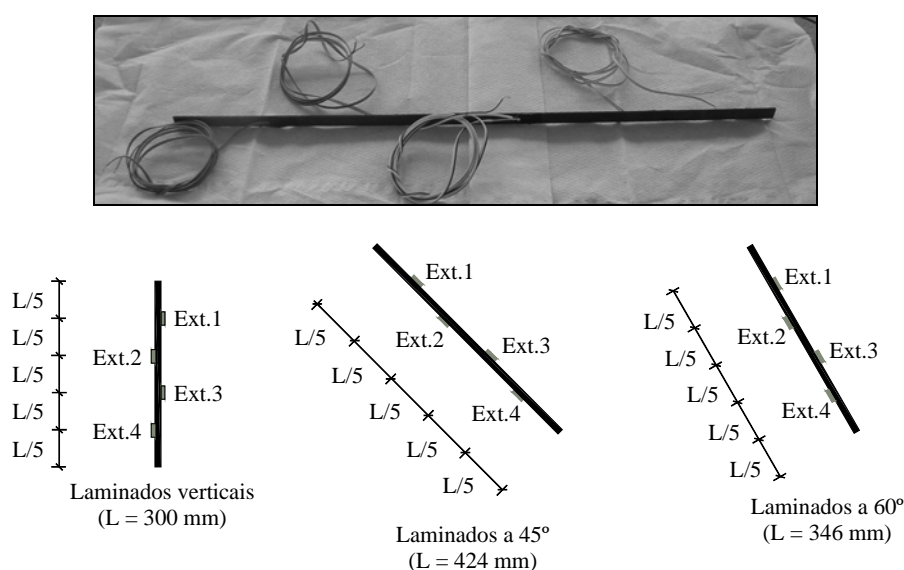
Disposição dos quatro extensómetros aplicados no laminado de CFRP instrumentado ao longo do seu comprimento L (Ext.1, Ext.2, Ext.3 e Ext.4).
